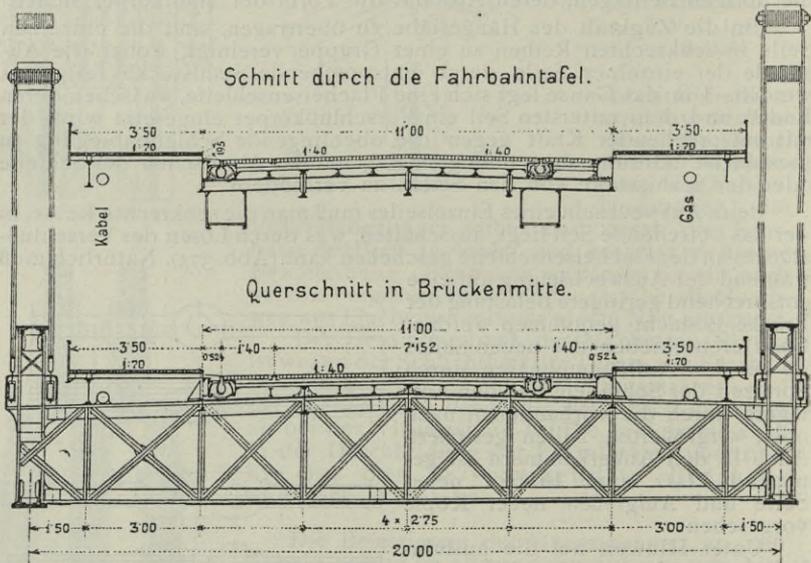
Querschnitt der Elisabeth-Brücke in Budapest. (D. B. Z. 1904 S. 151.)
